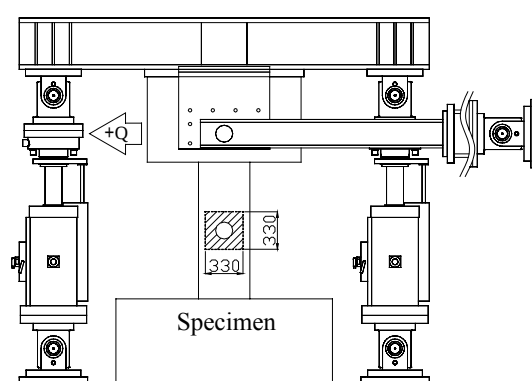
加力装置図 (斜線部: ひび割れ測定範囲)
